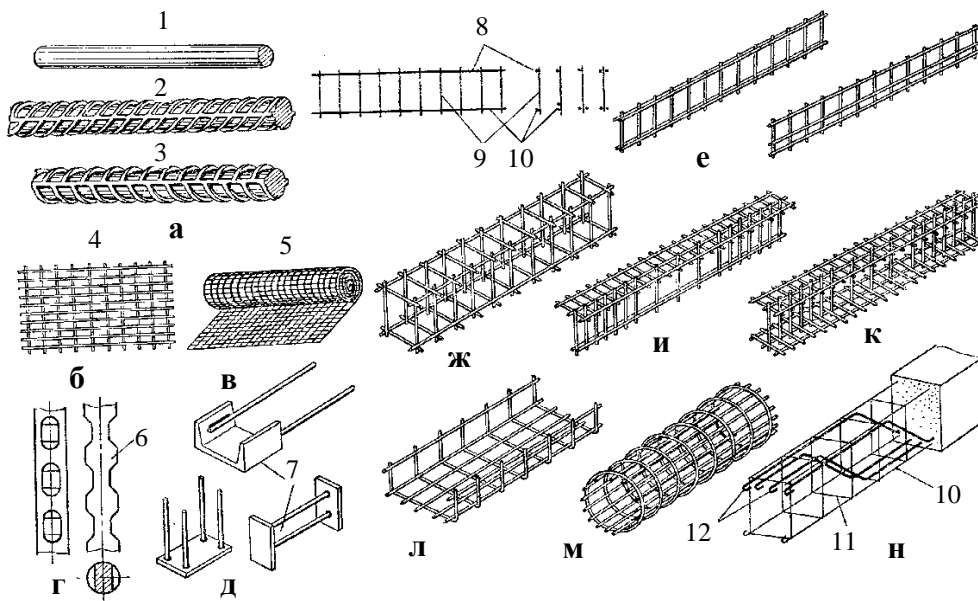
Види арматури: а – арматурні стрижні; б – плоска арматурна сітка; в – рулонна арматурна сітка; г – дріт; а – арматура періодичної дії; д – закладні деталі; е – плоскі каркаси; ж – просторовий каркас; и – просторовий каркас таврового перерізу; к – просторовий каркас двотаврового перерізу; л – гнутий каркас; м – циліндричний каркас; н – каркас з відігнутими стрижнями в'язаний; 1 – стрижень круглий гарячекатаний; 2, 3 – стрижень періодичного профілю; 4 – сітка зі стрижнів періодичного профілю; 5 – сітка з круглих стрижнів; 6 – профіль холодносплющеної арматури; 7 – способи кріплення закладних деталей до арматури; 8 – верхні монтажні стрижні; 9 – поперечні монтажні та робочі стрижні; 10 – нижні робочі стрижні; 11 – хомути; 12 – кінцеві гаки
